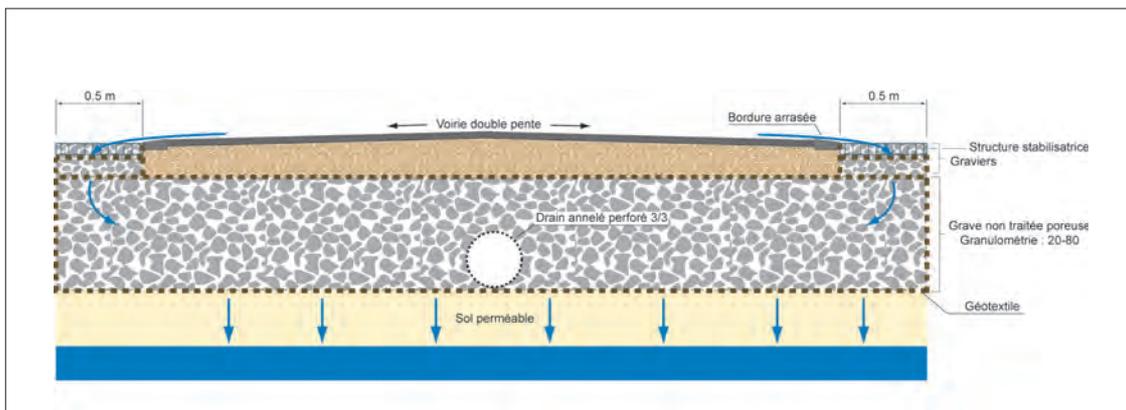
COUPE EN TRAVERS VOIRIE A DOUBLE PENTE & RIVES DRAINANTES
